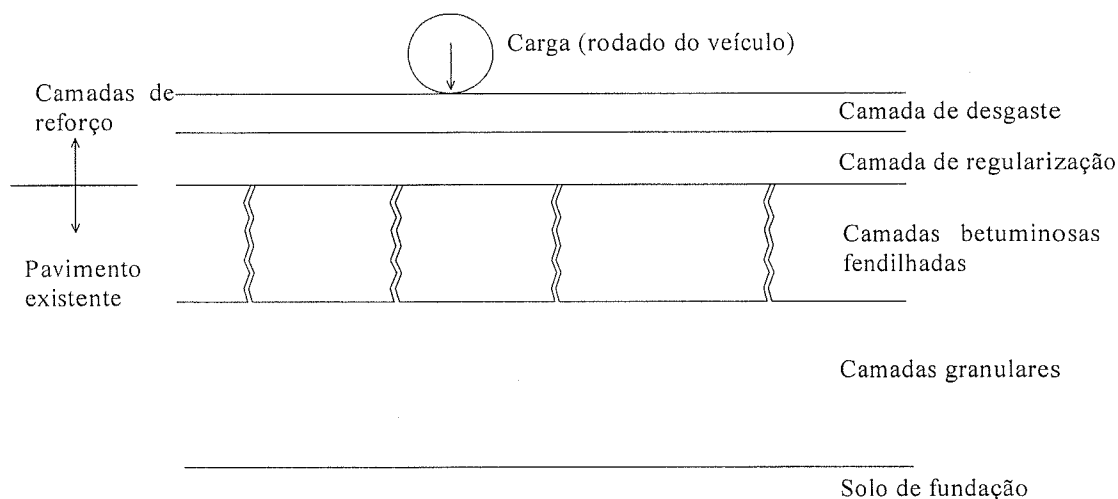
Representação esquemática da estrutura do pavimento após reforço
